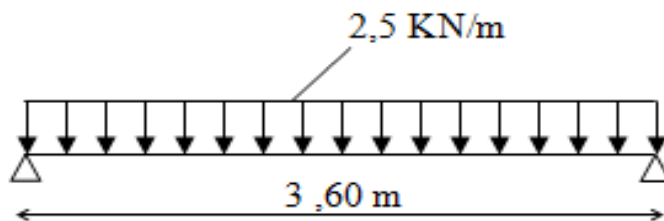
Schéma statique de calcul de la poutrelle.
